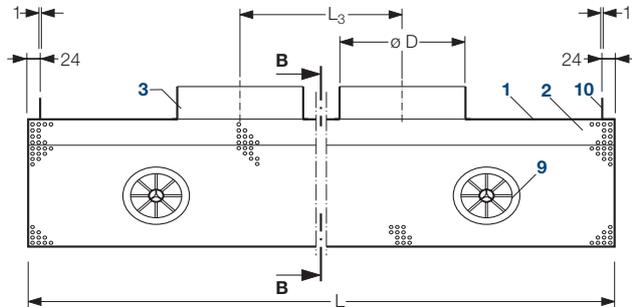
Trapezförmiger Verdrängungsauslass, Abmessungen
